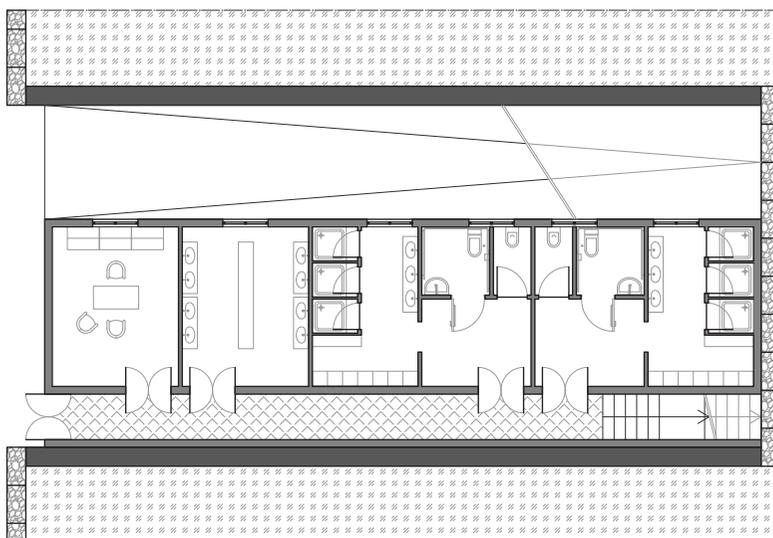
\_ Pianta Blocco dei servizi, rielaborazione dell'autrice.
